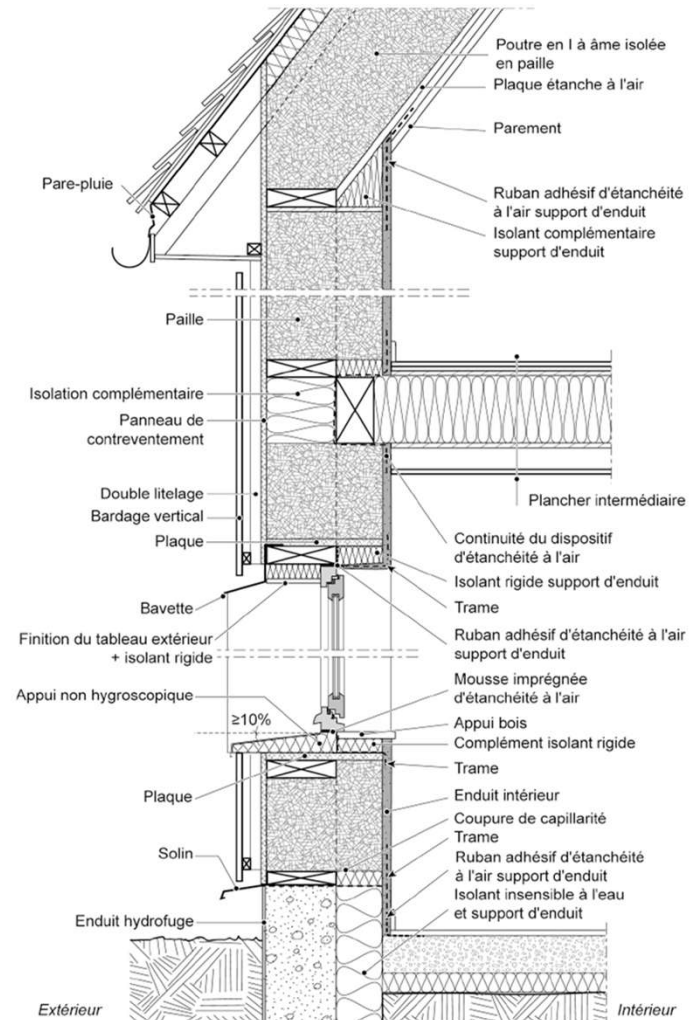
Exemple de coupe verticale d'une paroi avec ossature simple désaxée vers l'extérieur
